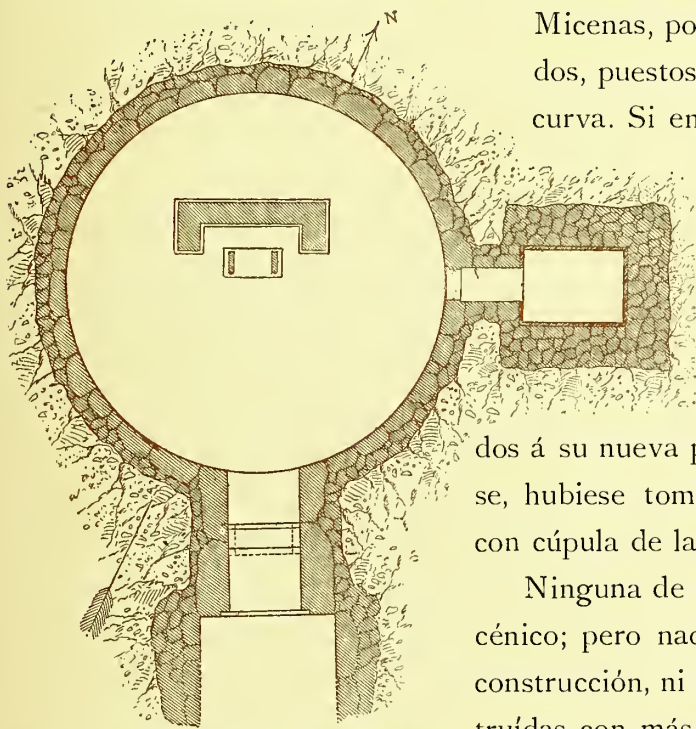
PLANTA DE LA TUMBA DE ORCOMENOS
